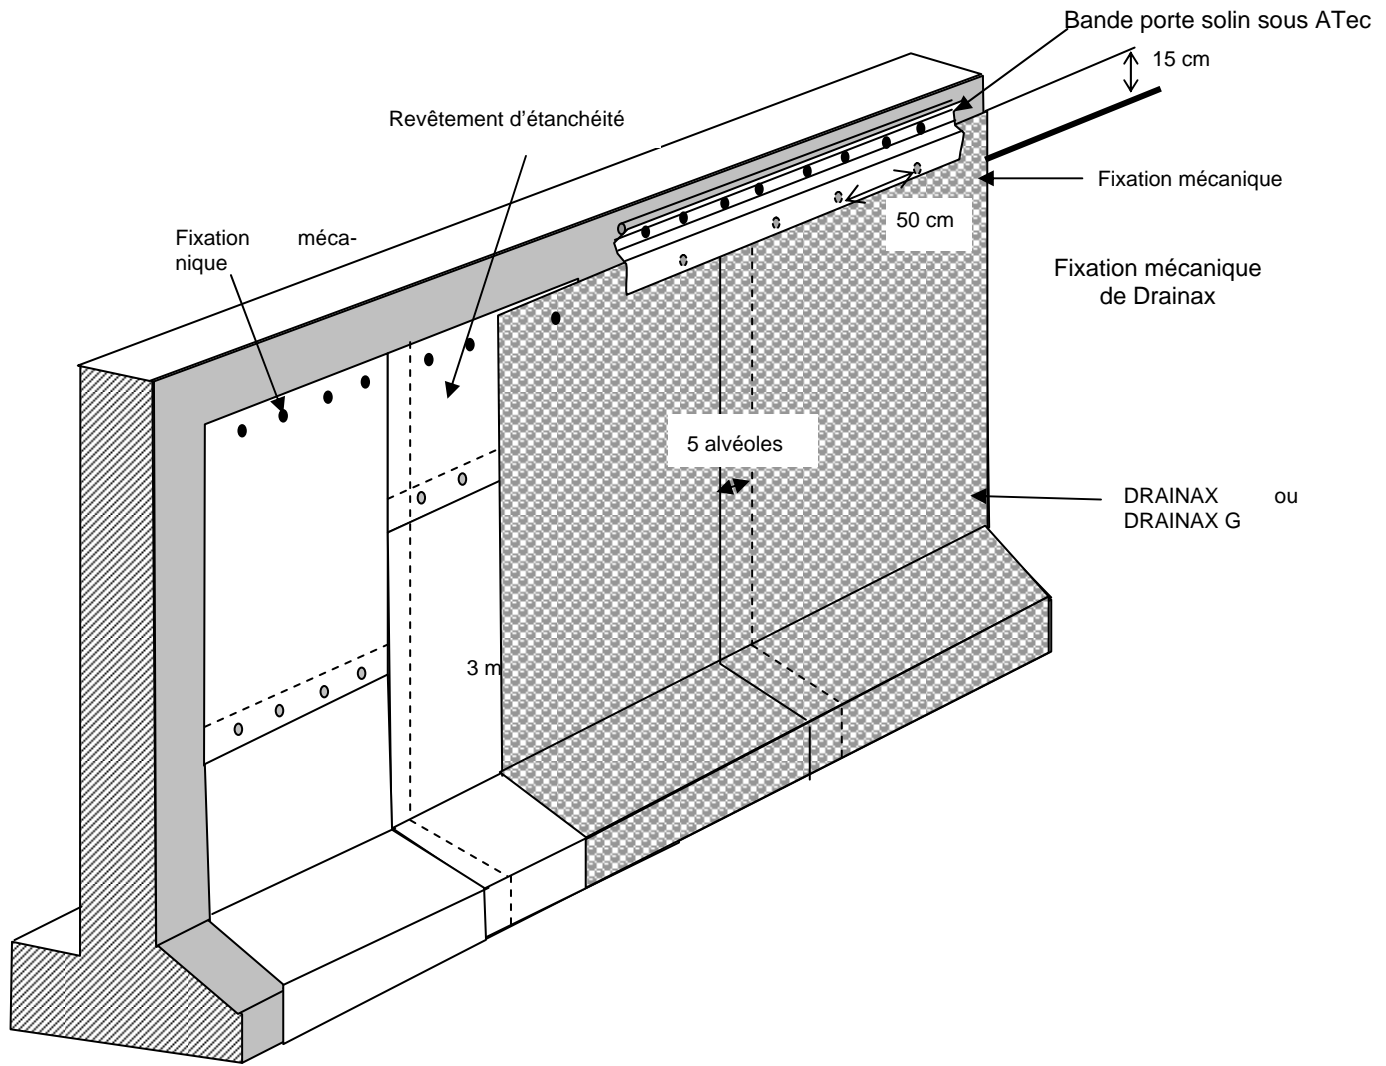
bis – Exemple de mise en œuvre du DRAINAX / DRAINAX G sur revêtement d'étanchéité pour $h > 2$ m
